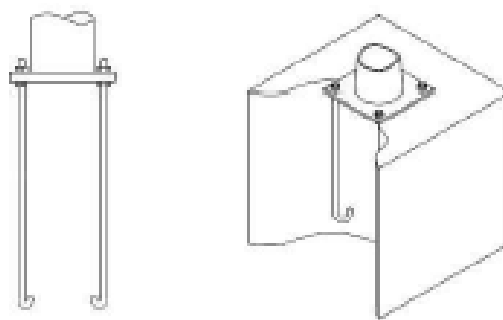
Detalle de pernos y bloque de hormigón para el anclaje de la farola.
